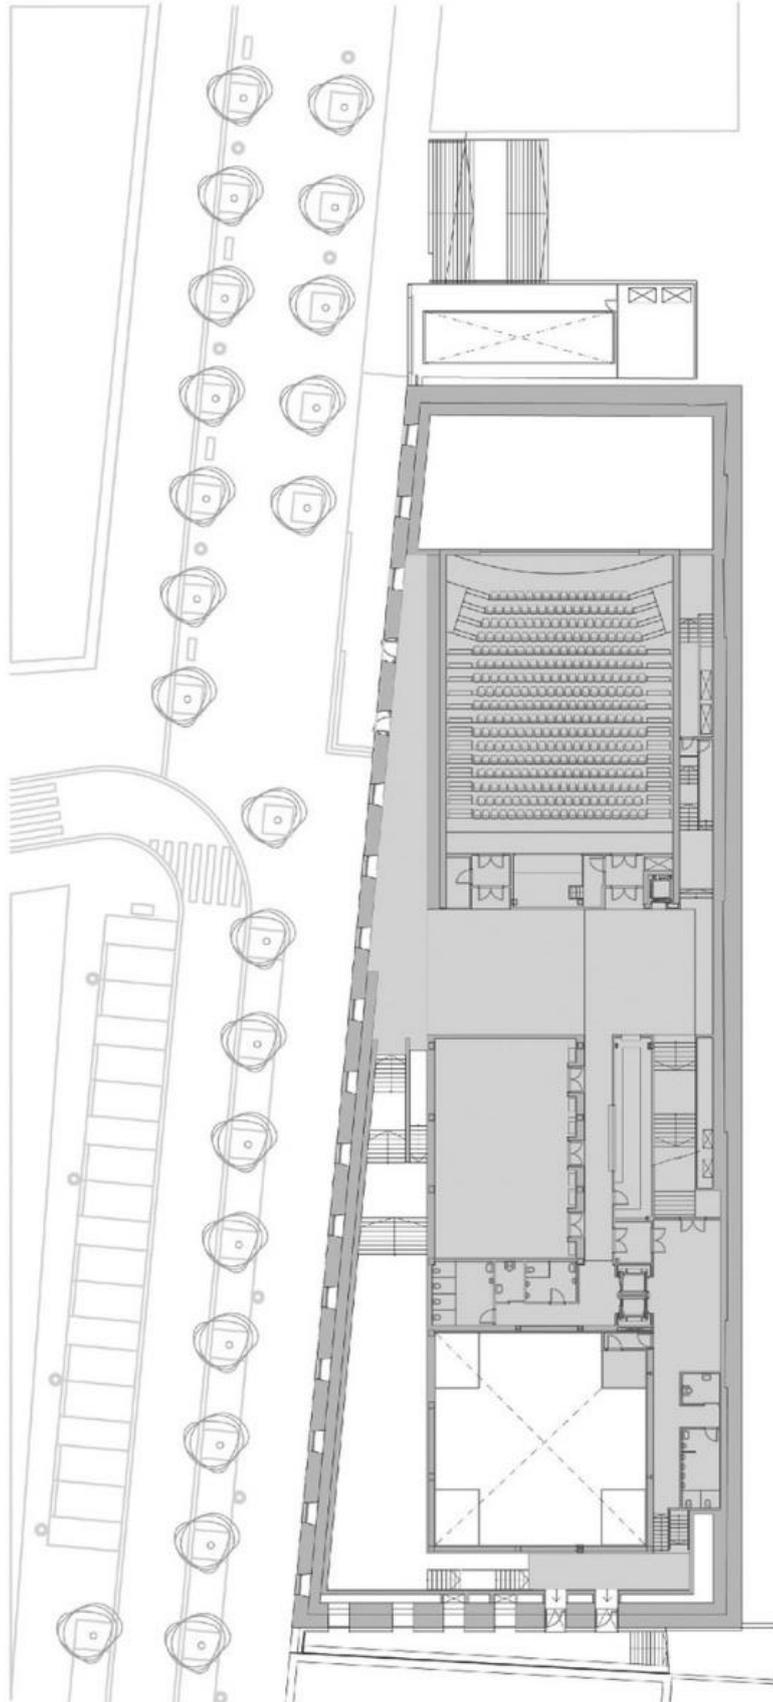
Planta do Piso R/Chão do Centro Cultural Daoíz e Velarde
